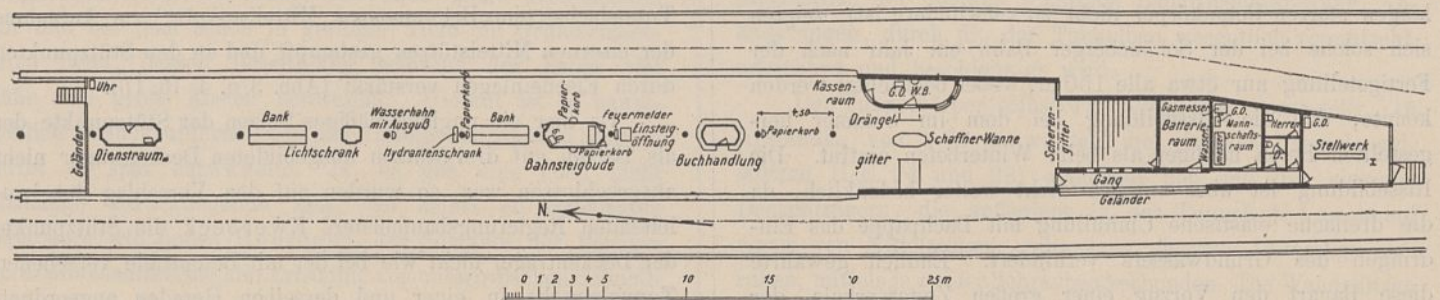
Grundriß der Haltestelle Hauptstraße.
